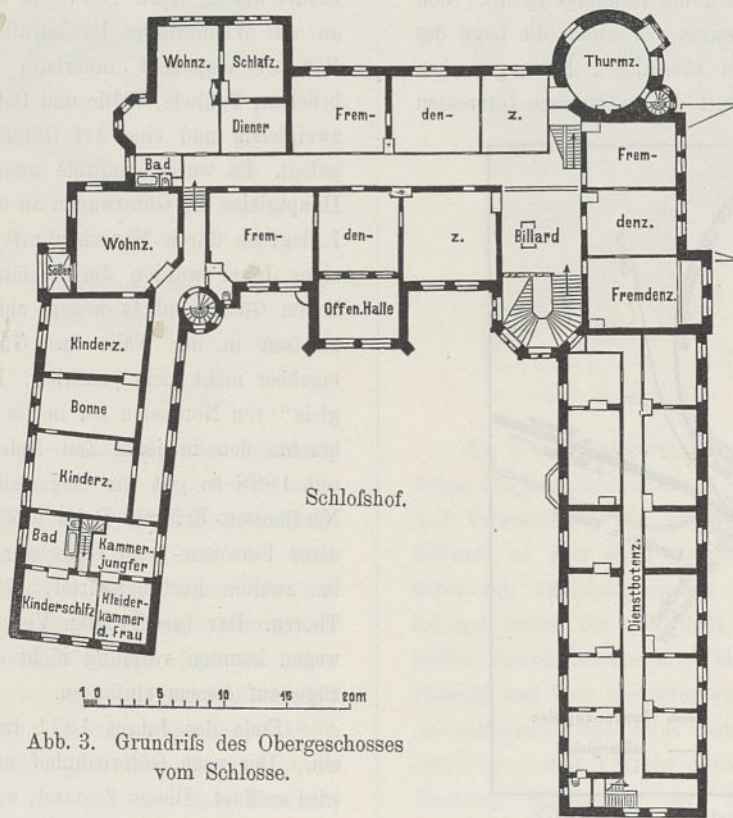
Grundriss des Obergeschosses vom Schlosse.
